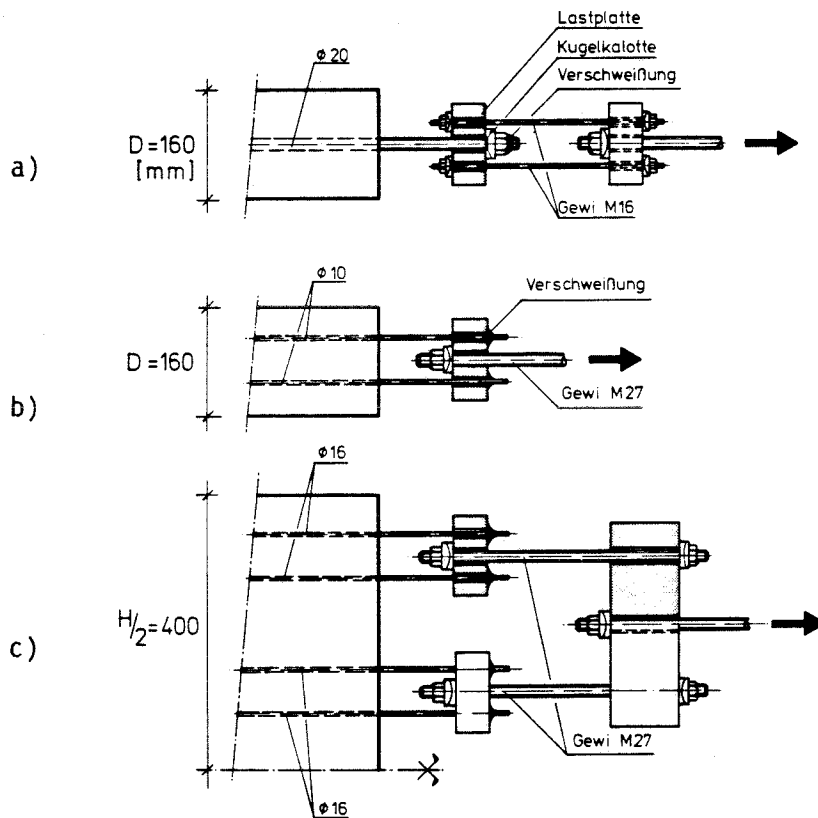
Anschluß der Zugkraft an die einbetonierten Bewehrungsstäbe
